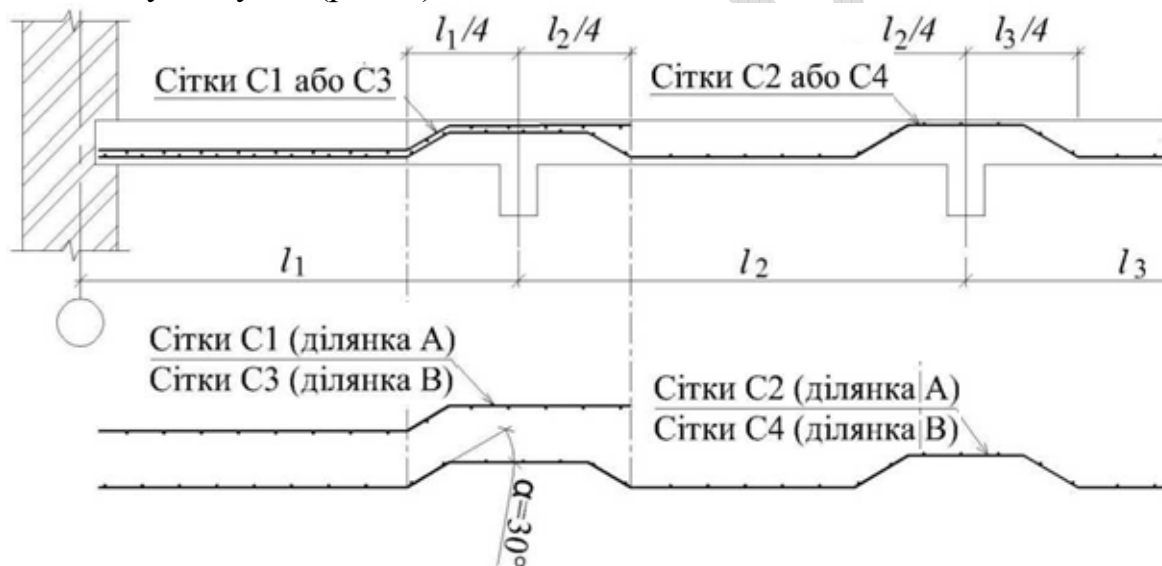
Армвання плити рулонними зварними сітками з поздовжньою робочою арматурою
